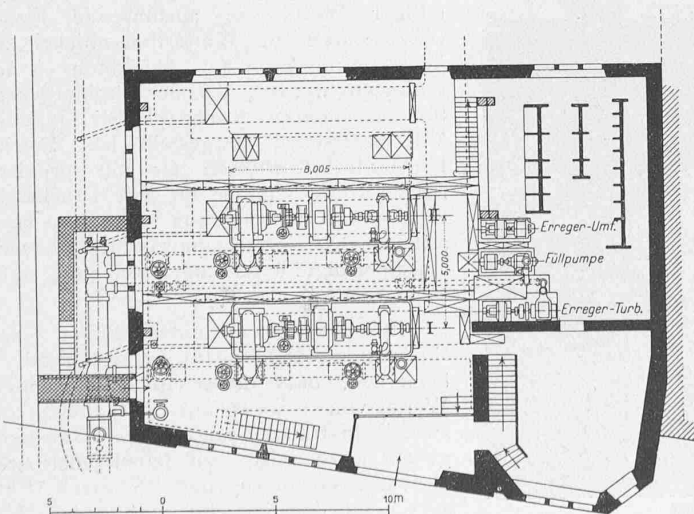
Zentrale C, Grundriss und Schnitt. — Masstab 1 : 300.
